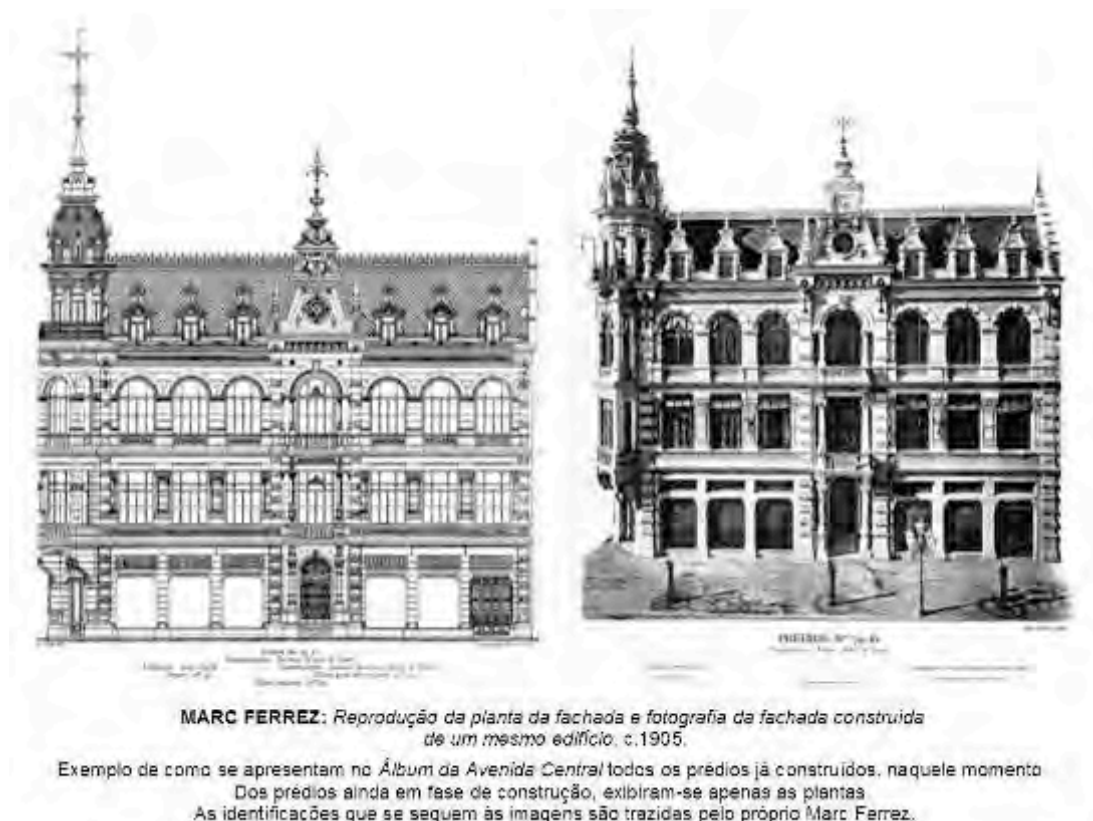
Reprodução de planta da fachada e fotografia da fachada construída de um mesmo edifício. Marc Ferrez, 1905.
